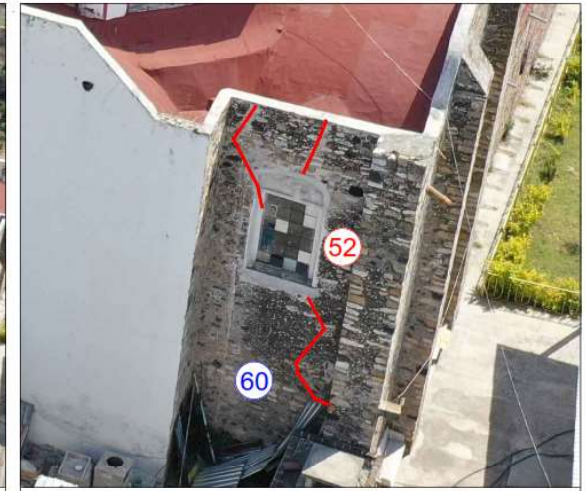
grietas y faltante de aplanado en el presbiterio.
